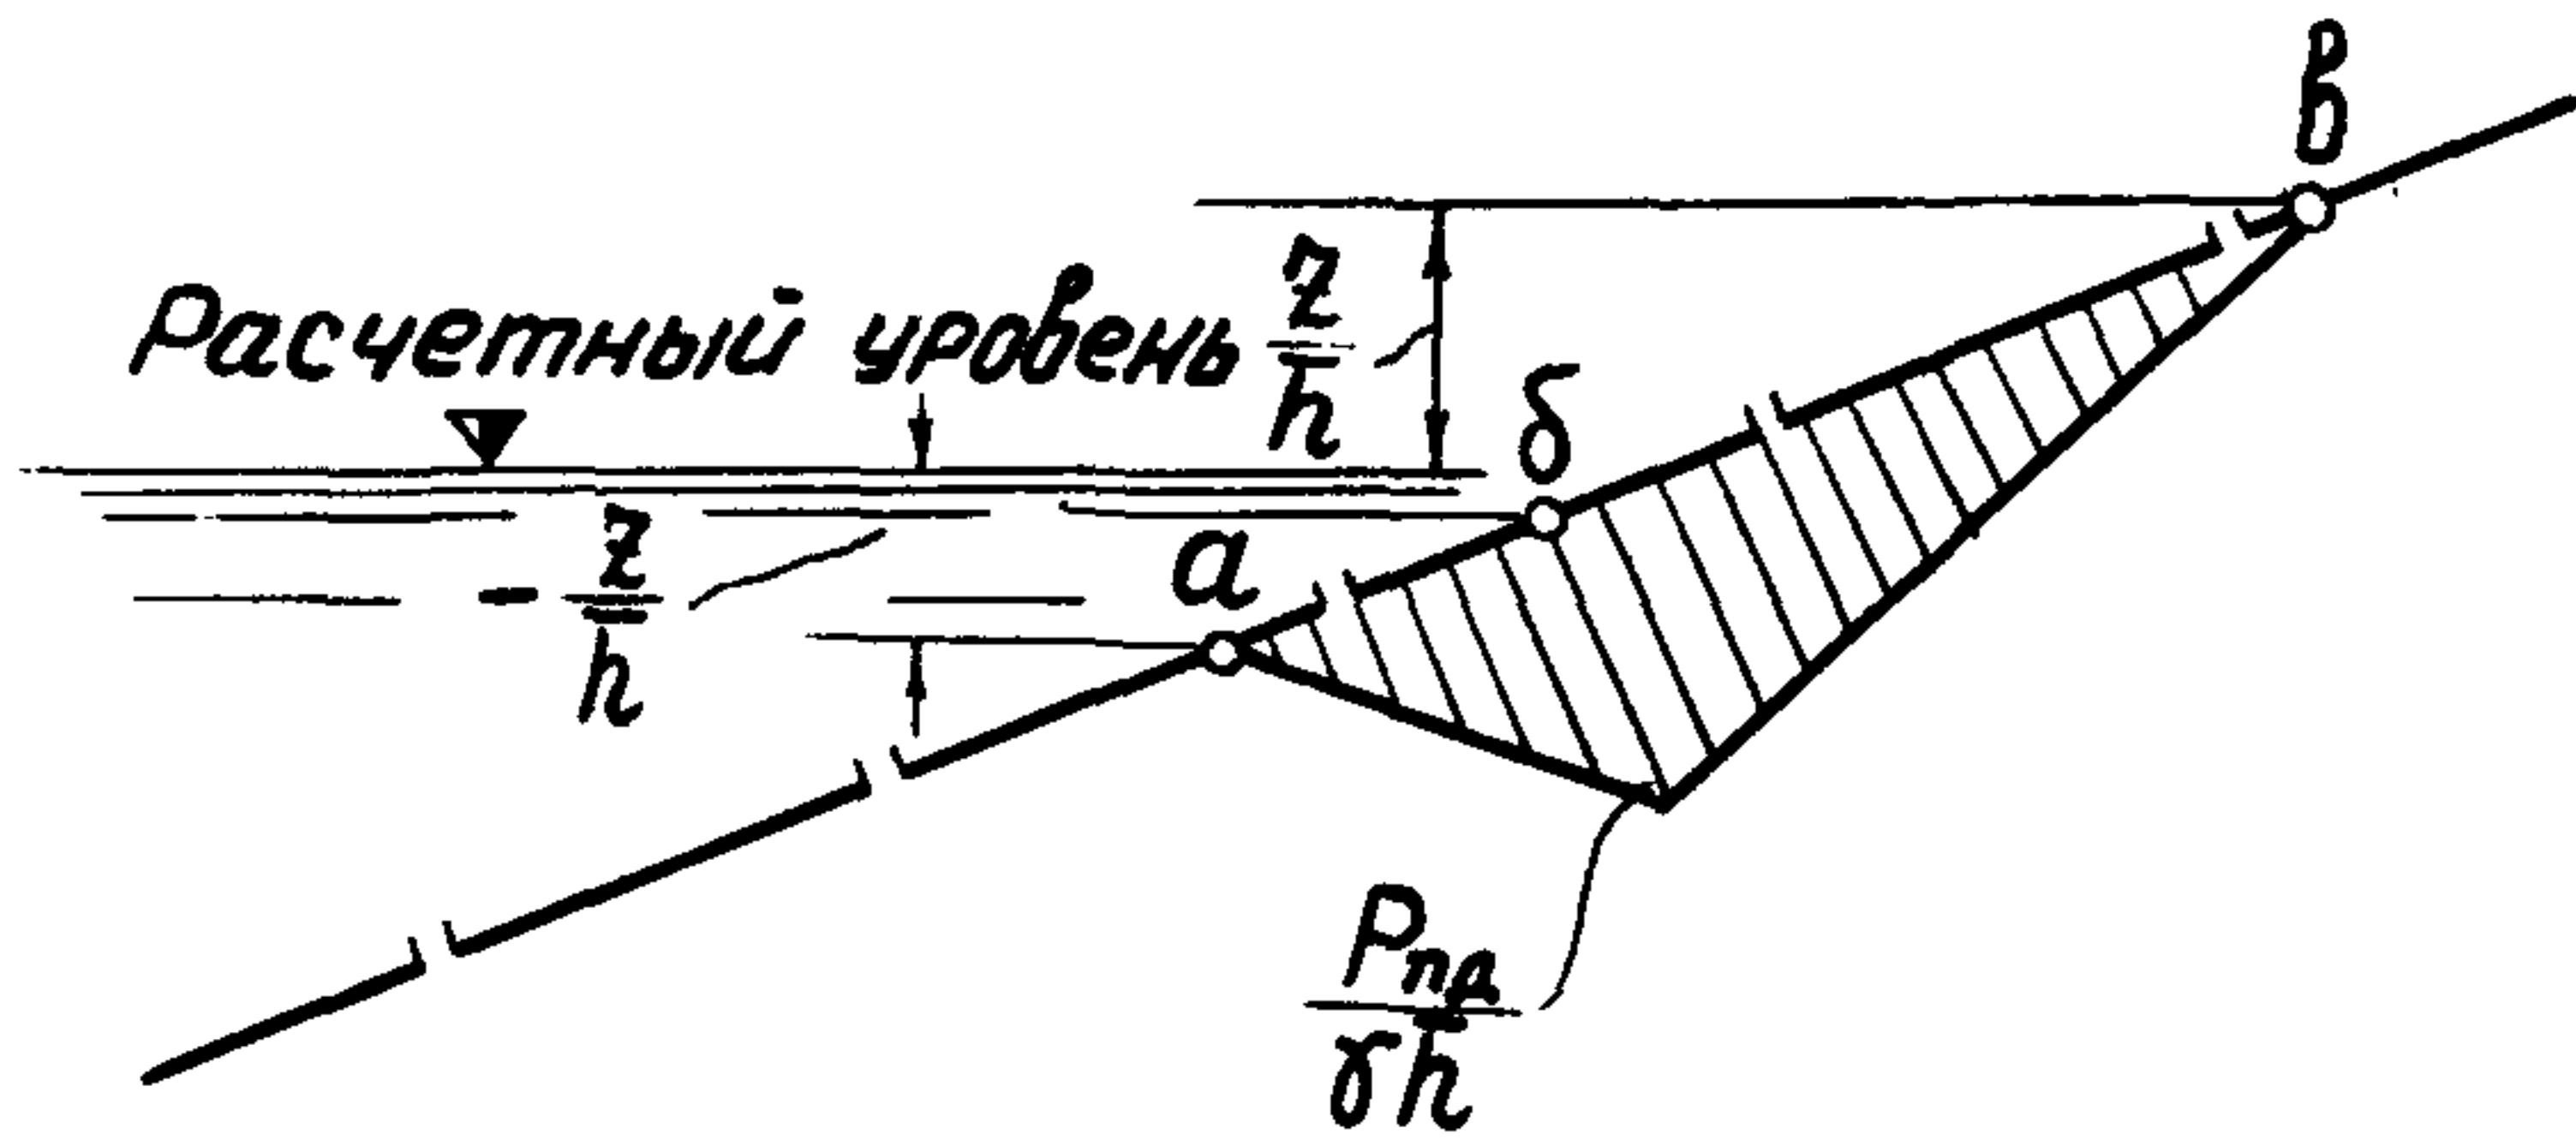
Типовая эпюра взвешивающей нагрузки на сквозное (плитное) покрытие откоса с площадью отверстий до 6% от поверхности откоса при нерегулярном волнении.
